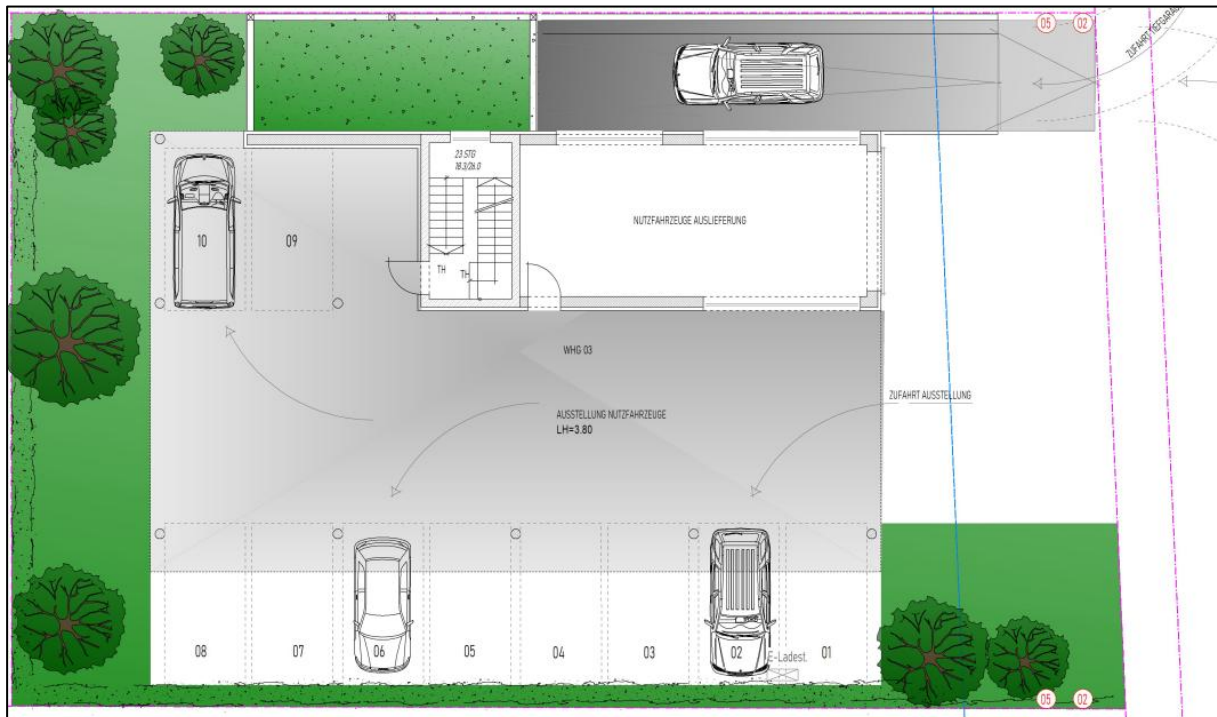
Grundrissplan Erdgeschoss Vorhaben Flur-Nummer 501/1 [13]
